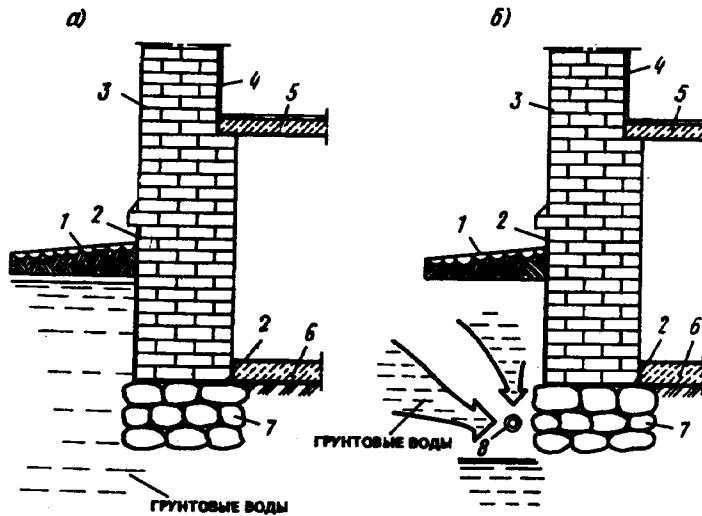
Конструктивные мероприятия по защите от увлажнения грунтовыми водами стены подвального помещения
